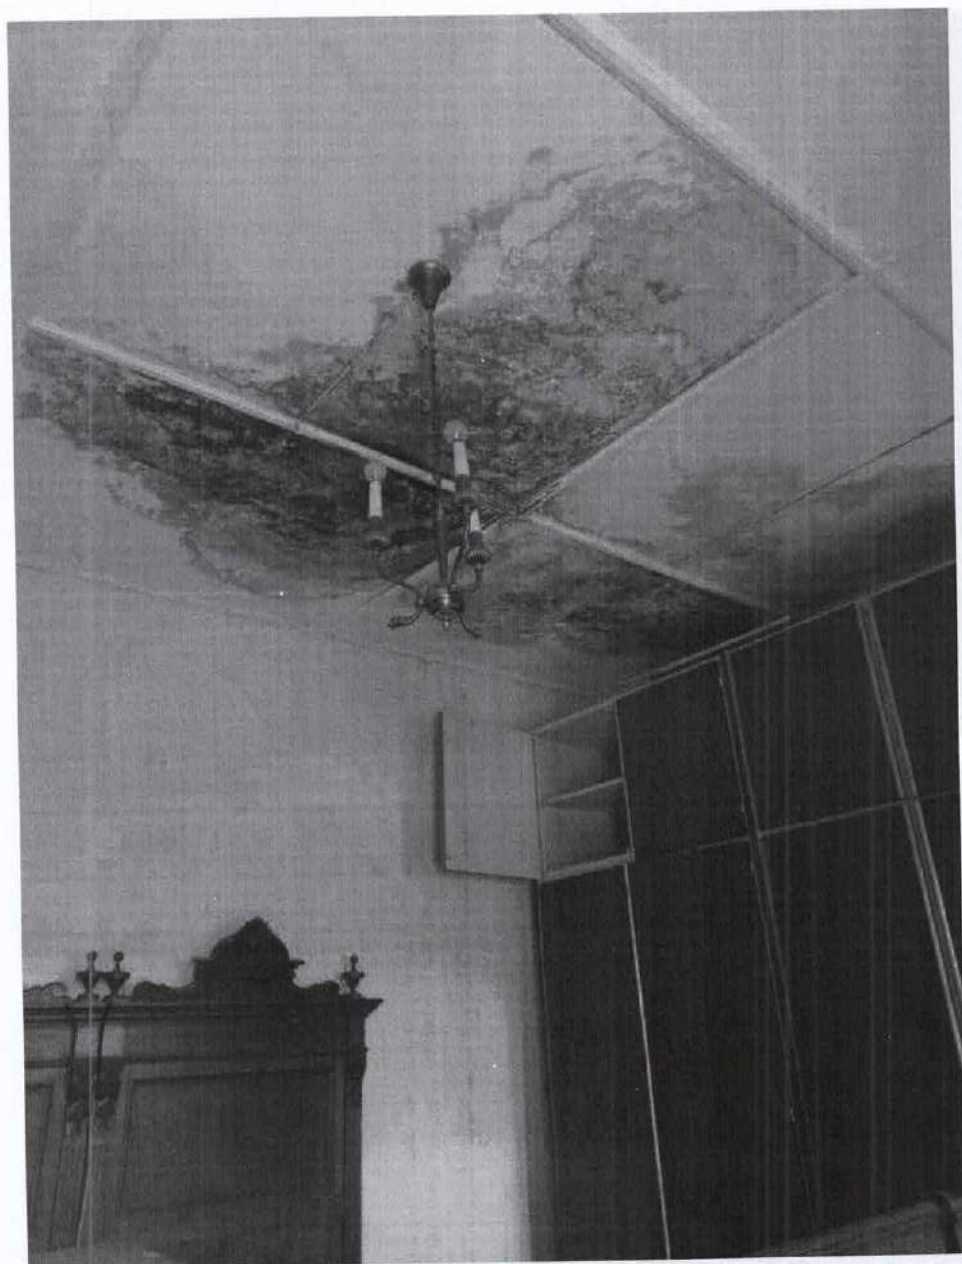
marcescenza controsoffitto del solaio di copertura del piano primo
